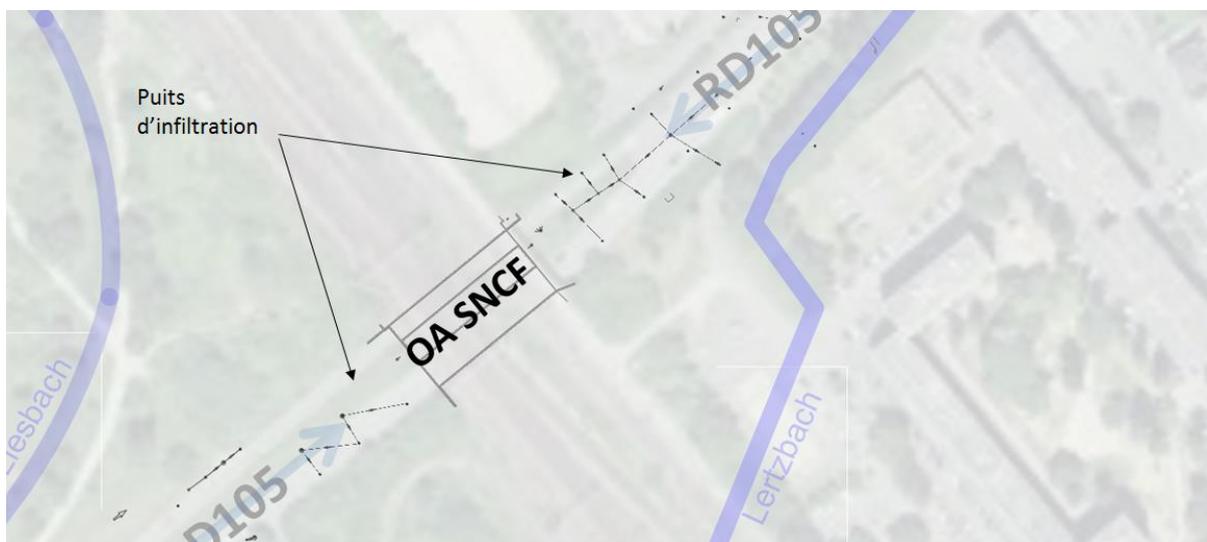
Zone de captage Eau potable et assainissement existant sur la section Ouest de la RD105
